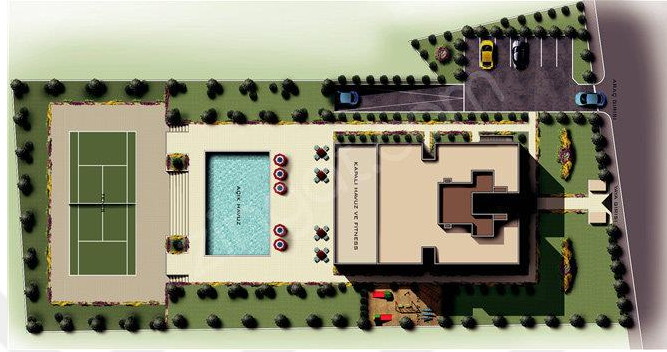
Yeni Yapının Kesiti ve Vaziyet Planı
